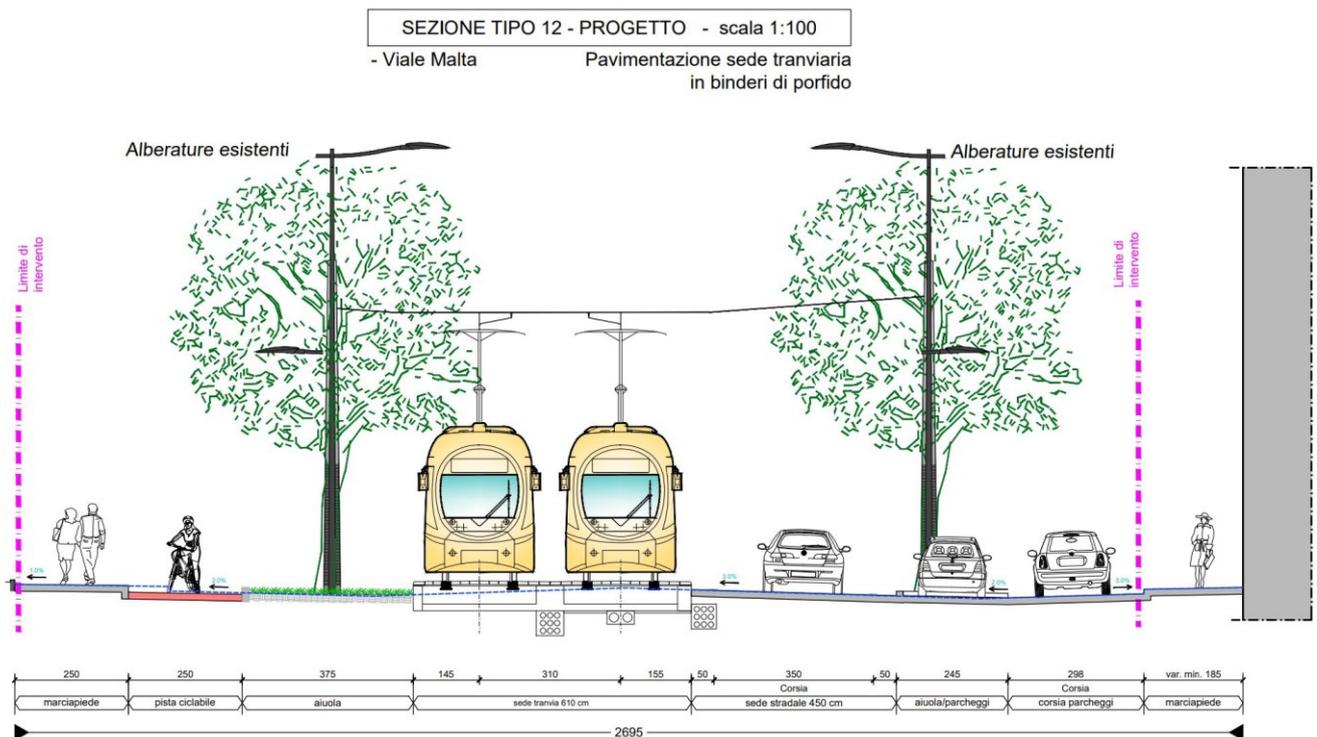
Sezione di progetto su viale Malta nel tratto ovest
